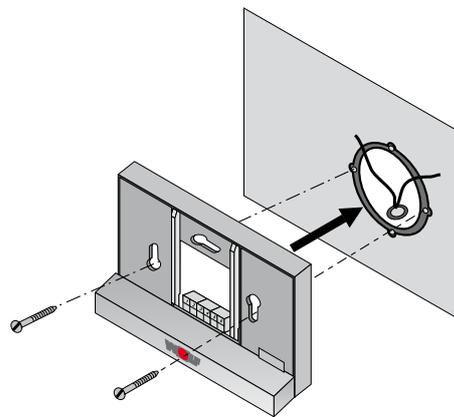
Monter le socle mural BM-2 sur boîte à encastrer (montage sur site)
